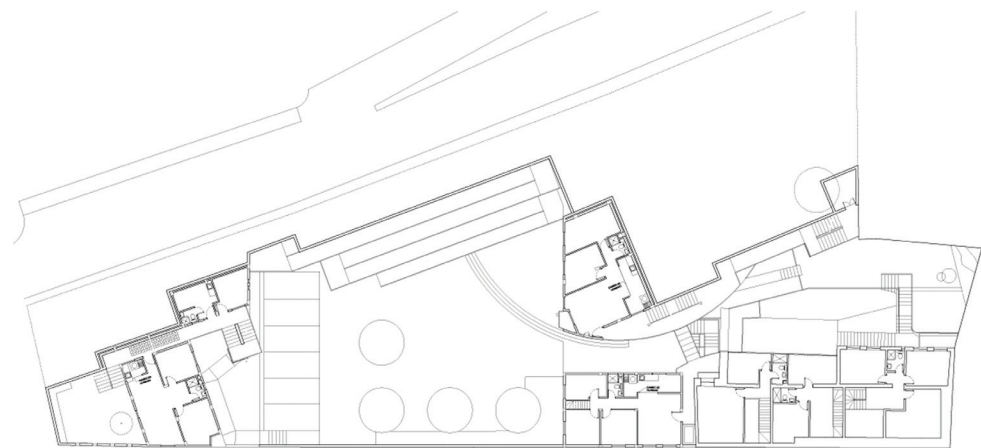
Planta N=+ 11.97, 12.90, 13.40
